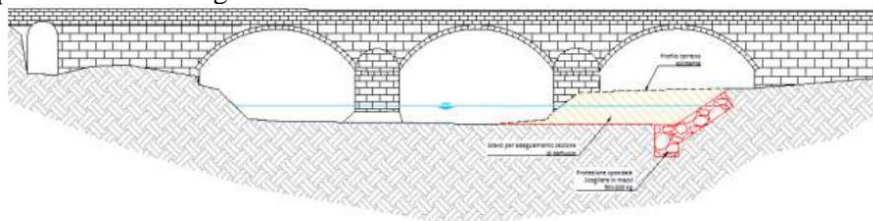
Sezione di progetto intervento ponte AT2200 a Fontecchio.
